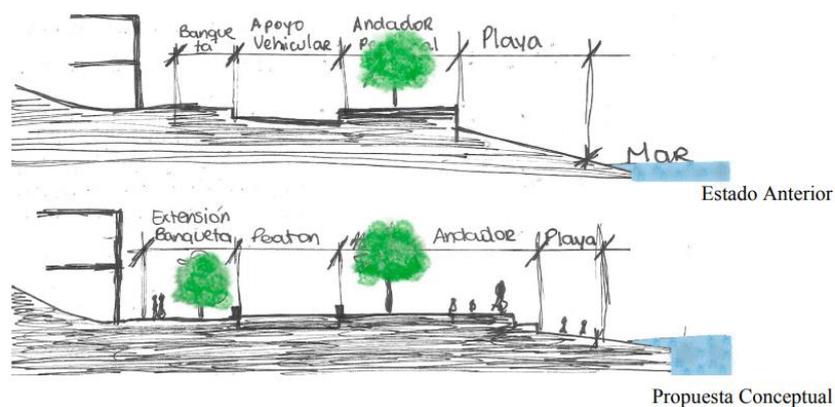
vista de sección estado anterior y propuesta conceptual
